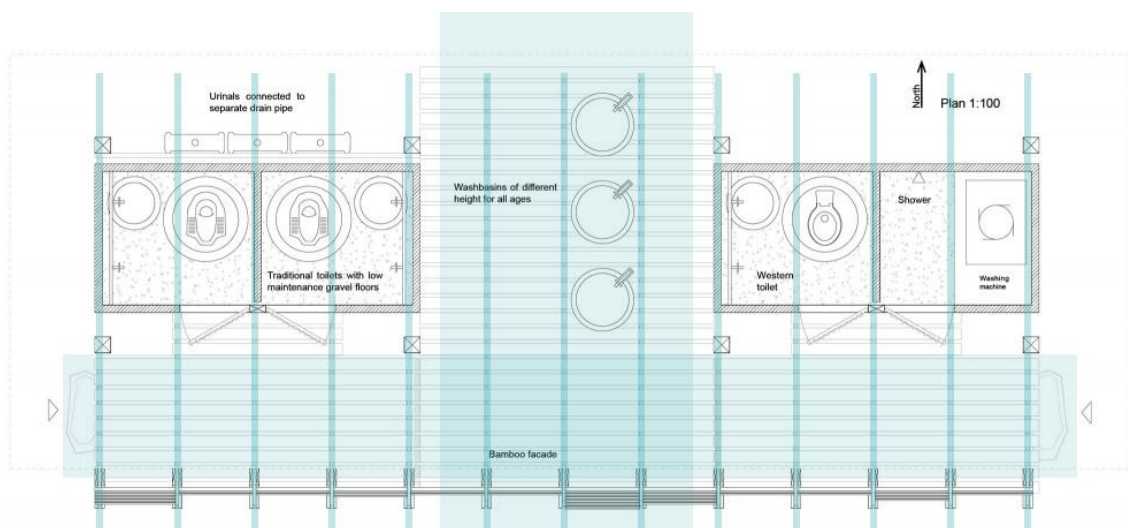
“Safe Heaven Bathhouse”, planta. Alterações do autor.
